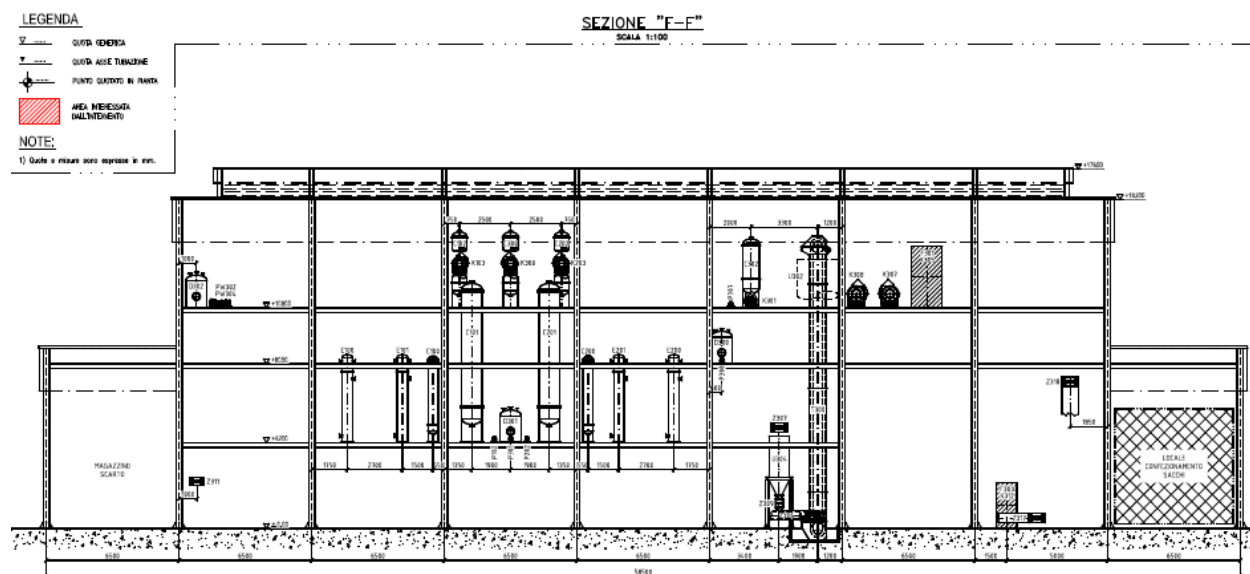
Progetto definitivo delle opere (sezione “F-F”)
